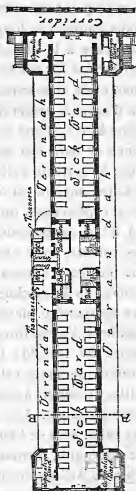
Hôpital Tollet (plan du rez-de-chaussée).
